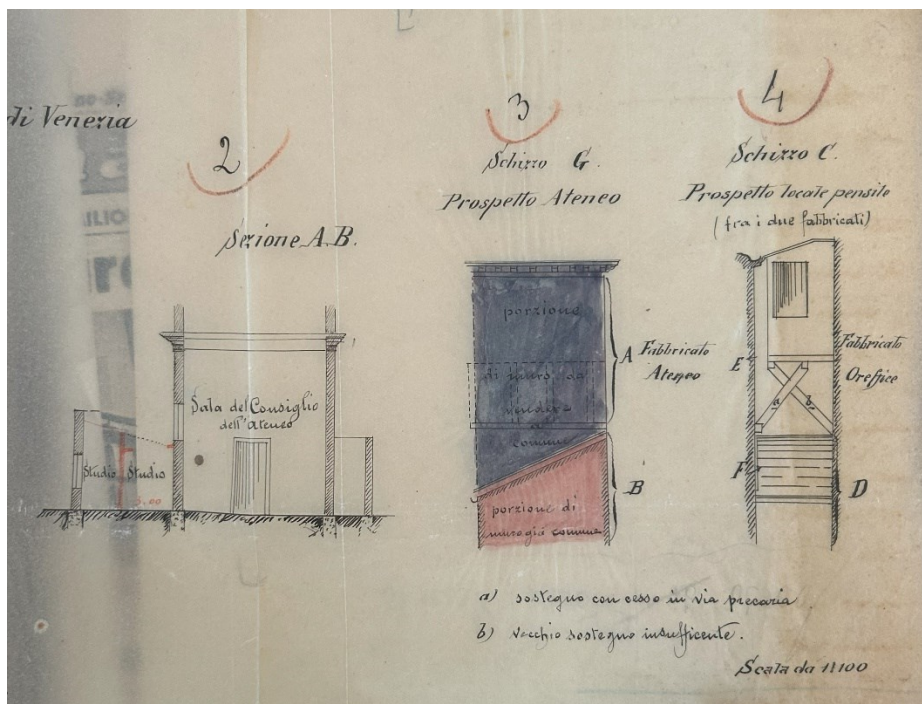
Progetto per la realizzazione dell'accesso in calle Minelli, sezioni e schizzi (ATVE, b. 64, 1913-1914, cart, "Restauri 1913-1914. Documenti. Conti")
